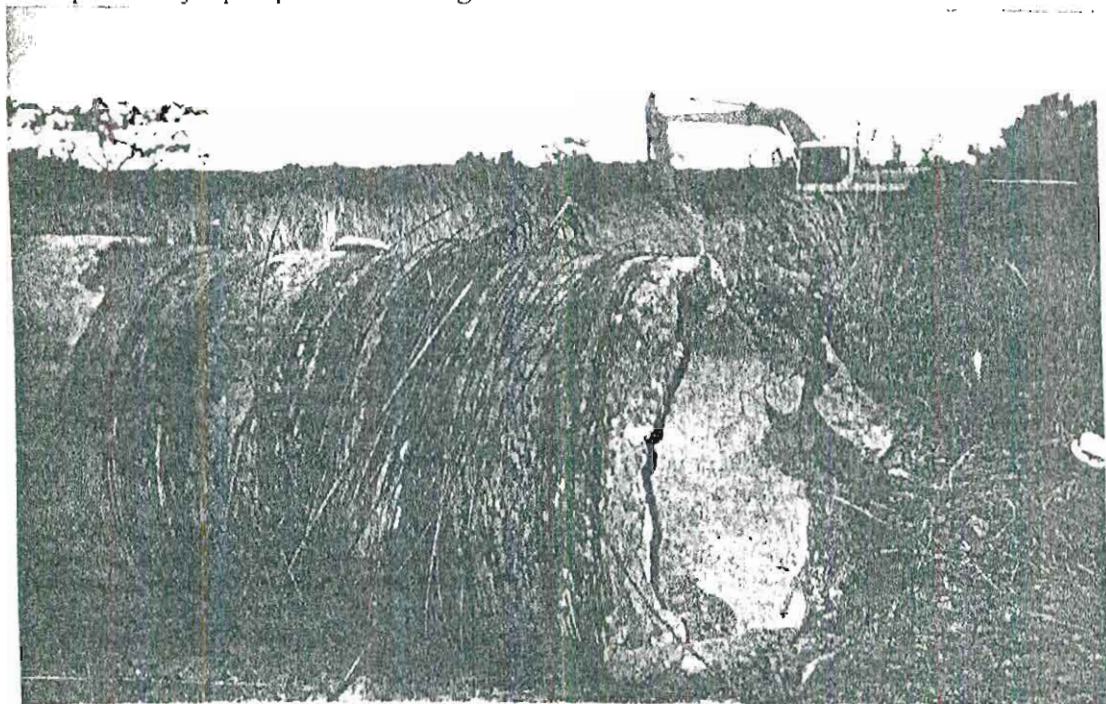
Tubería de Hormigón pretensado colapsada por la presencia de cloruros dentro de la mezcla de hormigón
